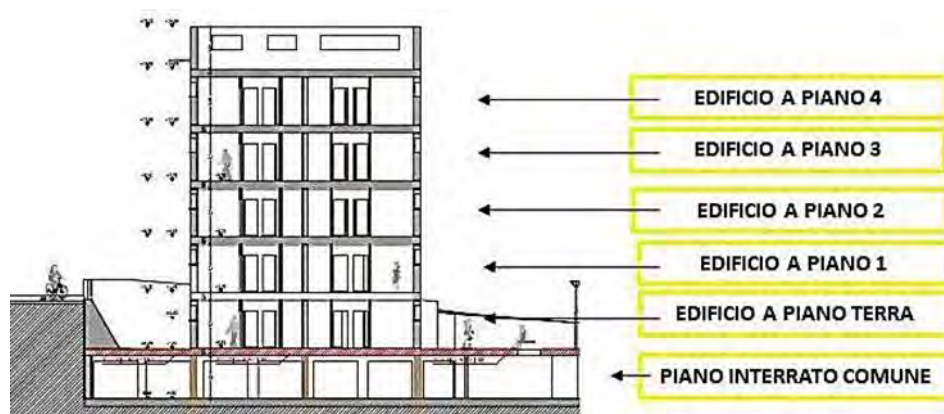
Prospetto verticale dell'utenza multifamiliare.
